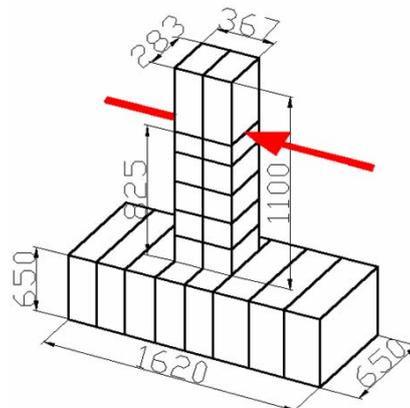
Type2 解析供試体の形状・寸法 (単位: mm)
